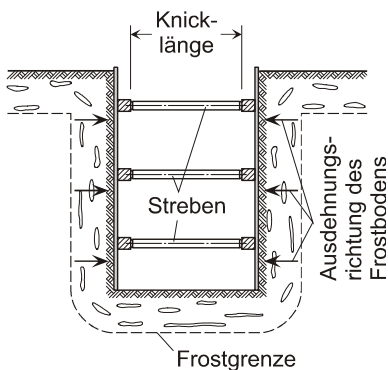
Frosteinwirkung bei mit einem verstrebt Verbau gestützten Baugrubenwänden
